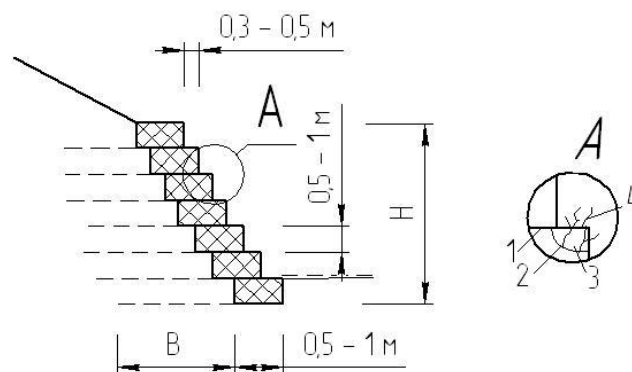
Поперечний профіль армогрунтової стінки: 1 – Террамеш;
